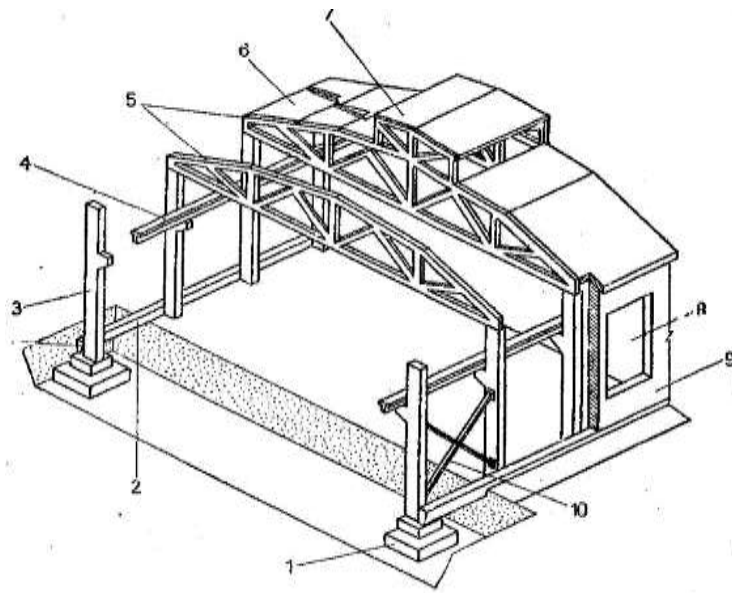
Основні конструктивні елементи одноповерхової виробничої будівлі: 1 – стовпчасті фундаменти; 2 – фундаментні балки; 3 – колони; 4 – підкранові балки; 5 – ферми; 6 – плити покриття; 7 – ліхтар; 8 – вікна; 9 – стіна; 10 – металеві в'язі.
